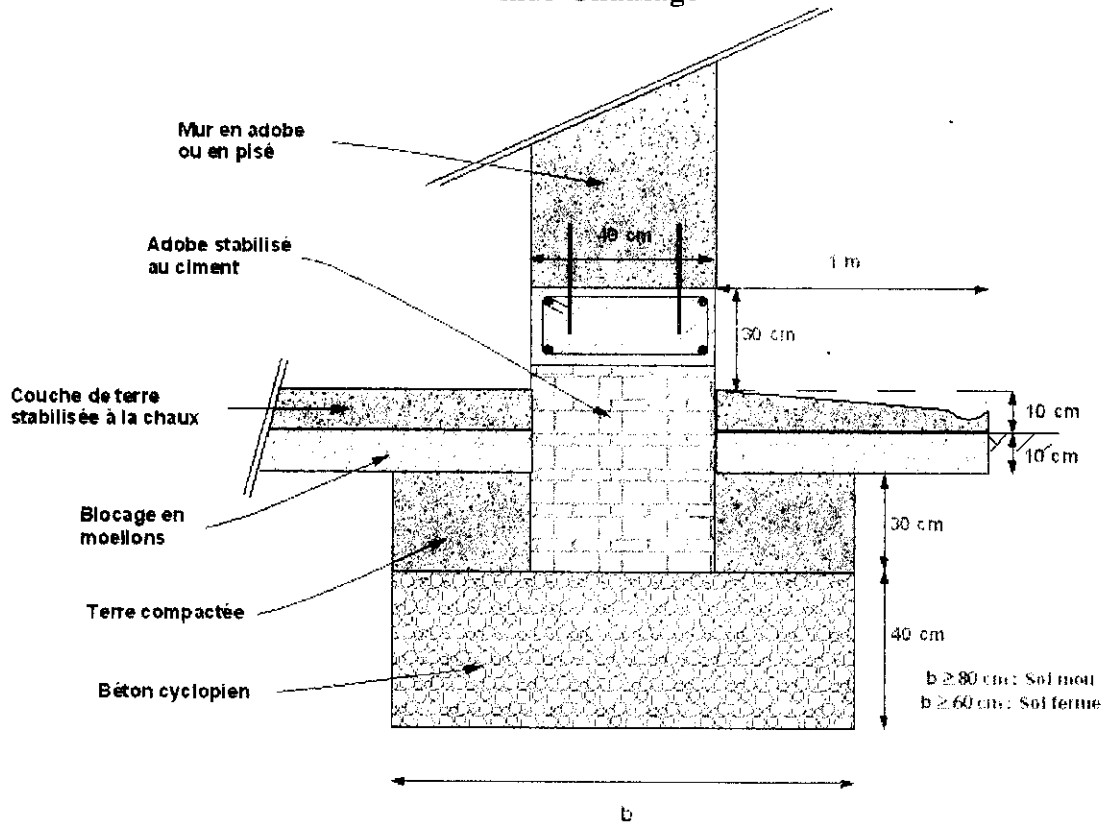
Fondation en béton cyclopéen + Chaînage en BA + Tiges d'attaches mur Chaînage
